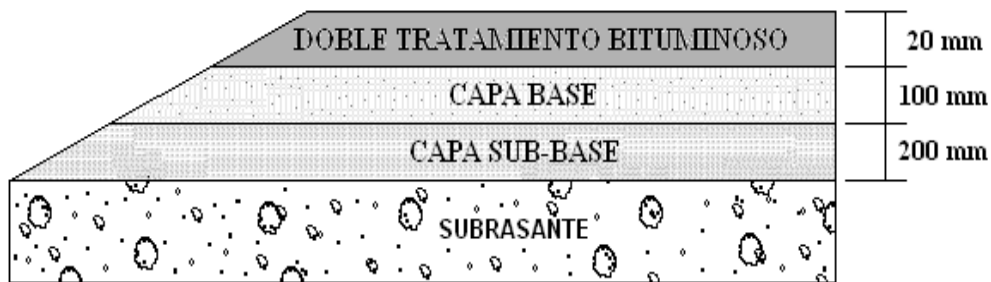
Esquema de la estructura final del pavimento tramo II.
